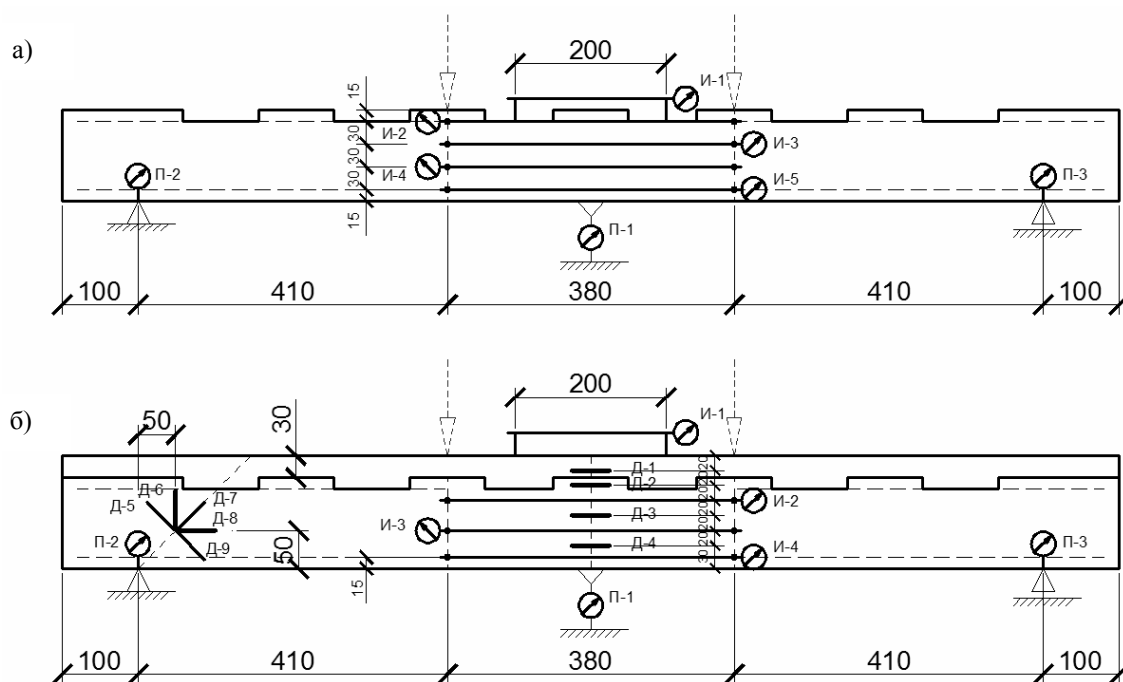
Схема установки приборов на опытной балке: а – базовой балки без усиления; б – балки, усиленной наращиванием сжатой зоны
